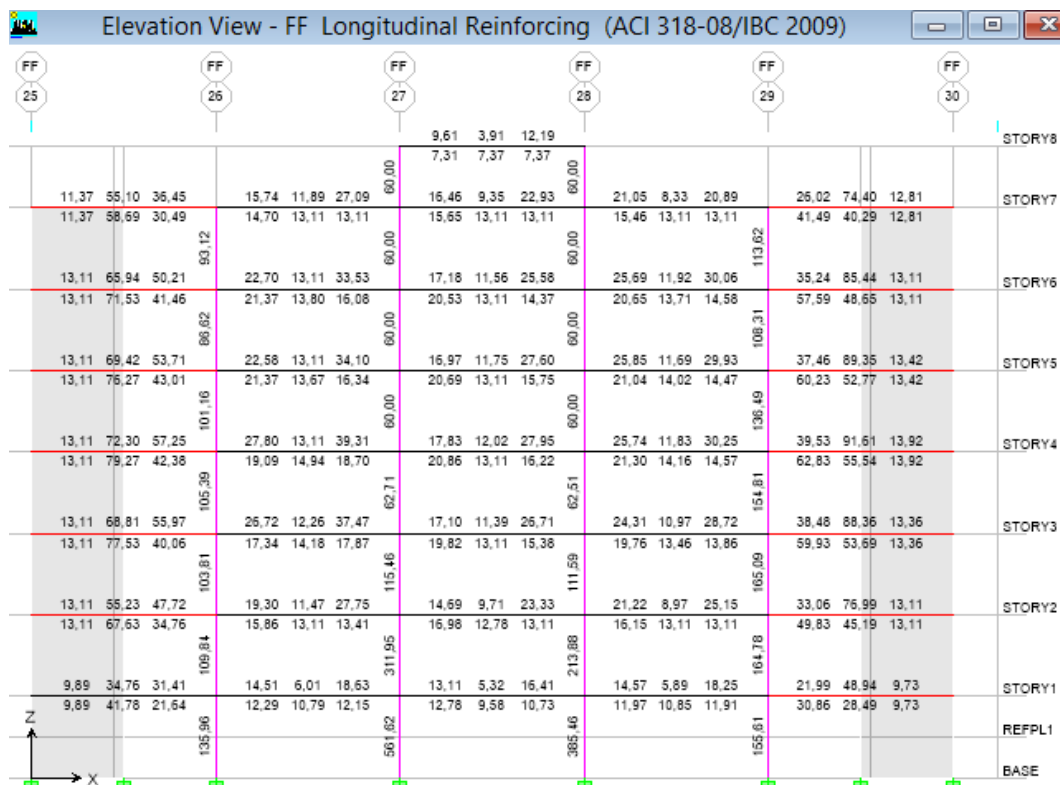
Acero en Vigas y Columnas en el Pórtico FF – Hospitalización 2- (NEC-11)
